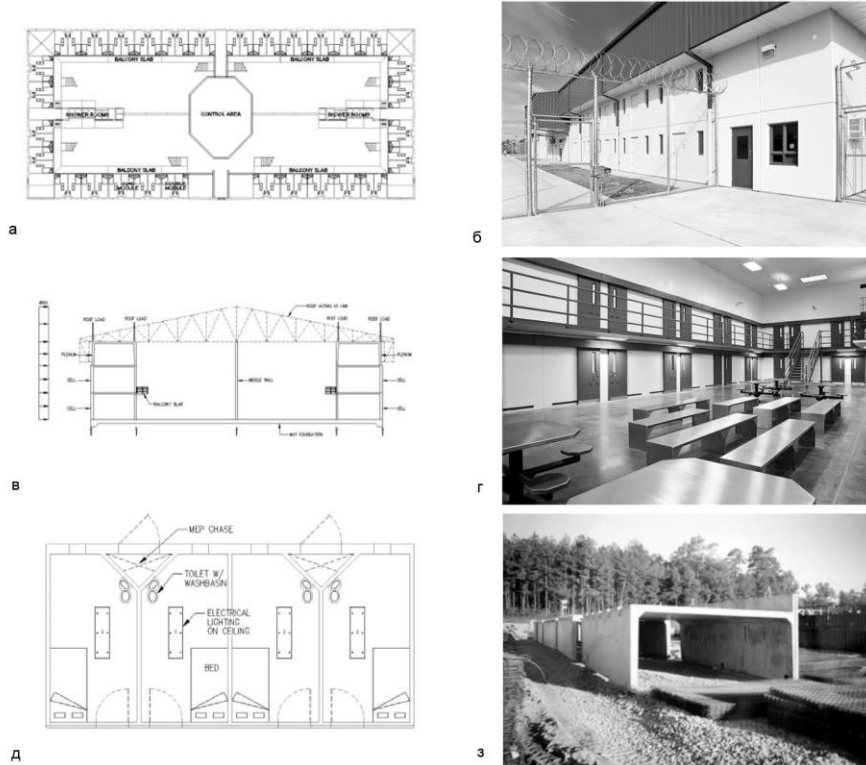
Виправний заклад, збудований з бетонних блок-модулів: а – план поверху; б – загальний вигляд; в – розріз; г – інтер'єр; д – план камер для засуджених; з – загальний вигляд монолітного бетонного модулю
